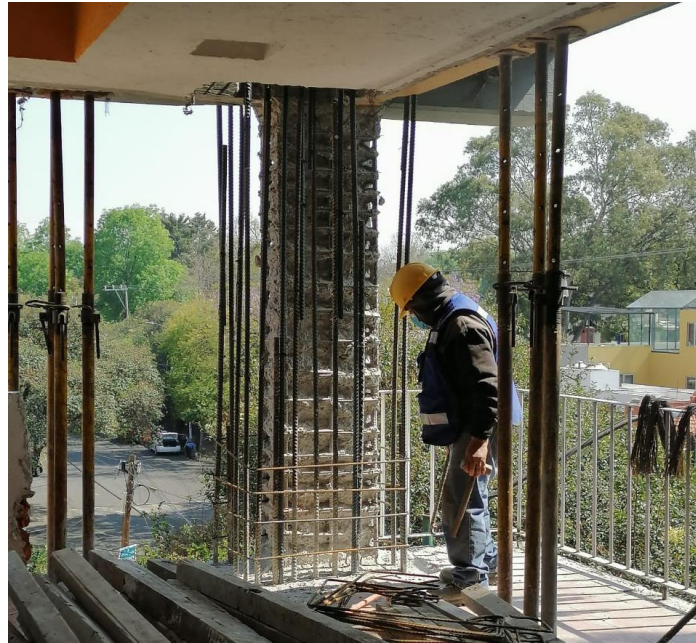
Apuntalamiento debido a la columna en proceso de encamisado
